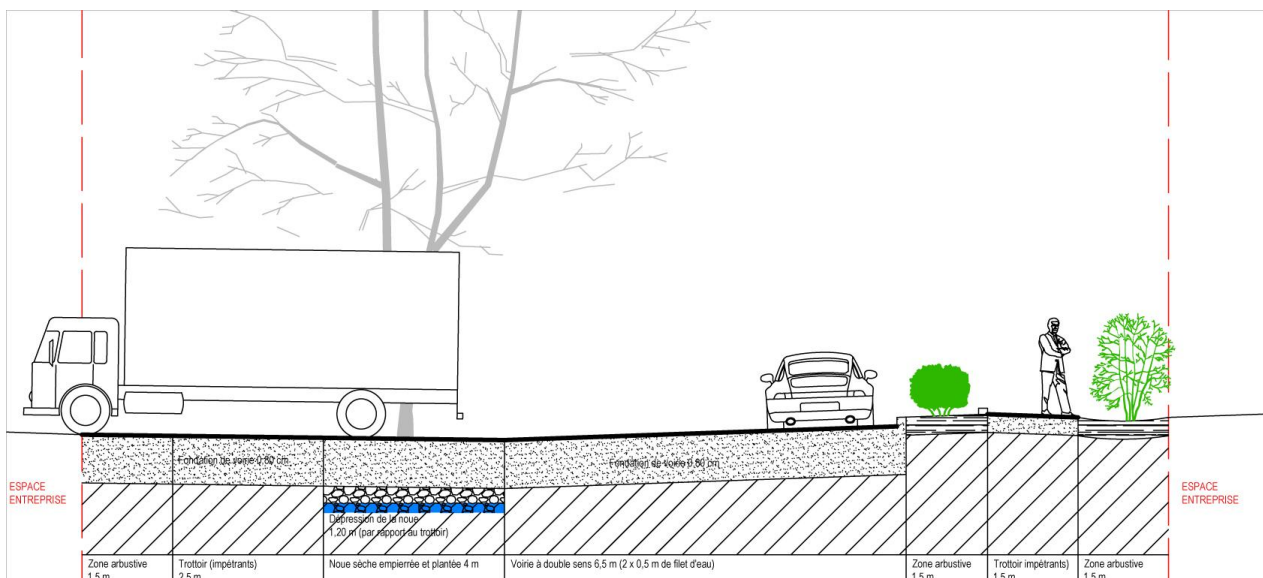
coupe technique de la voirie principale et du dispositif de traversée de la noue sèche à l'endroit de l'entrée des entreprises.
